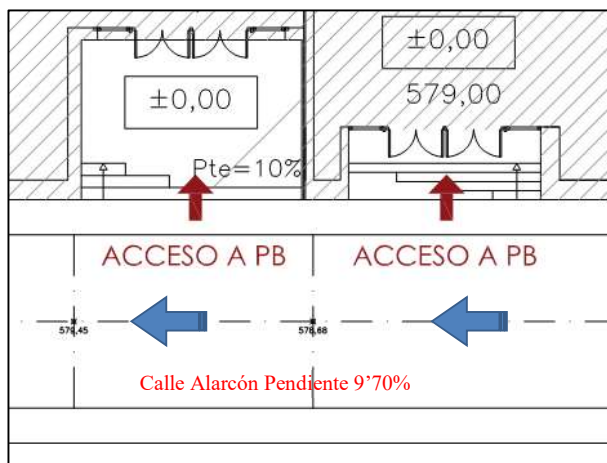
Acceso al edificio por calle Alarcón. Detalle del plano de Emplazamiento 1070E-00 (m1)
